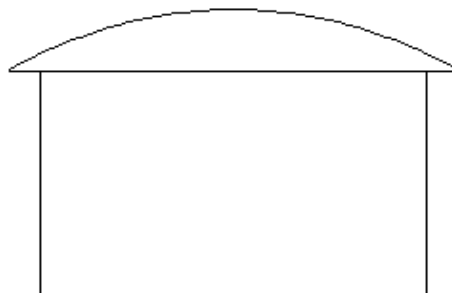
Surfaces des ouvertures sur la façade latérale droite
